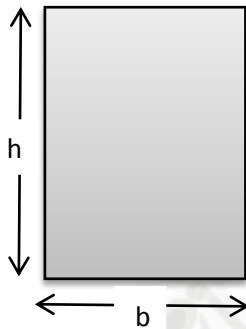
Diseño final de la losa maciza de entrespiso.
